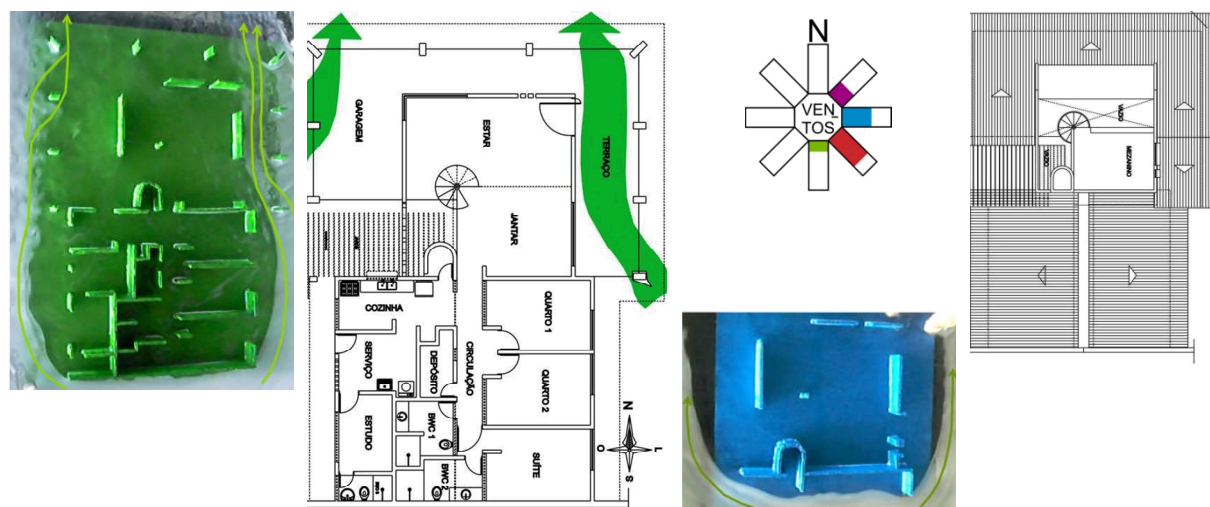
Ensaio e esquema do escoamento Sul no pavimento térreo e mezanino (E - Entrada; S - Saída)
